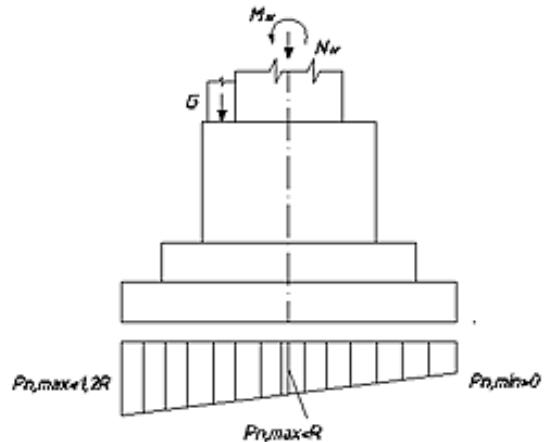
Расчетная схема усилий действующих на фундамент
